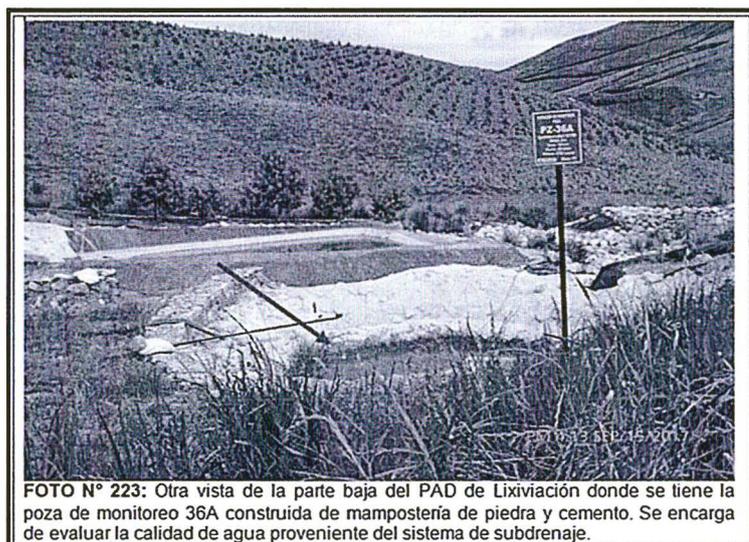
Otra vista de la parte baja del PAD de Lixiviación donde se tiene la poza de monitoreo 36A construida de mampostería de piedra y cemento. Se encarga de evaluar la calidad de agua proveniente del sistema de subdrenaje.
